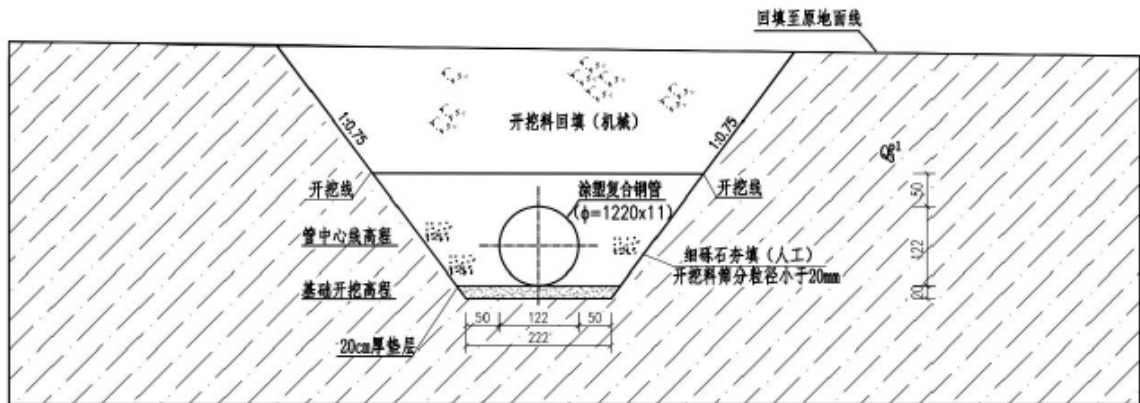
粉质壤土基础沟槽开挖典型横断面设计图
